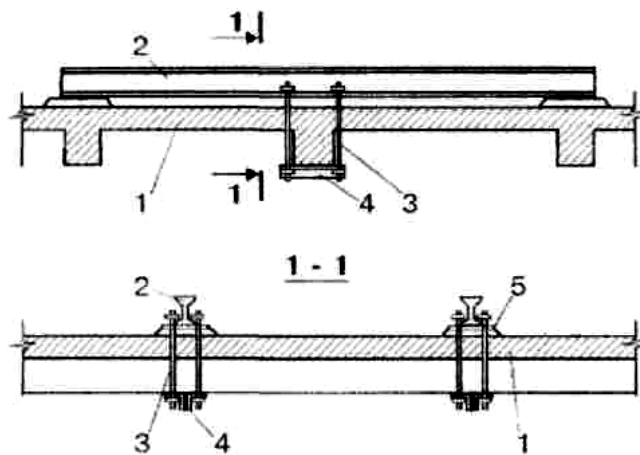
Схема підсилення балки перекриття розвантажувальними конструкціями: 1 – балка, що підсилюється; 2 – металева розвантажувальна балка; 3 – тяжі; 4 – планки; 5 – опорні елементи
